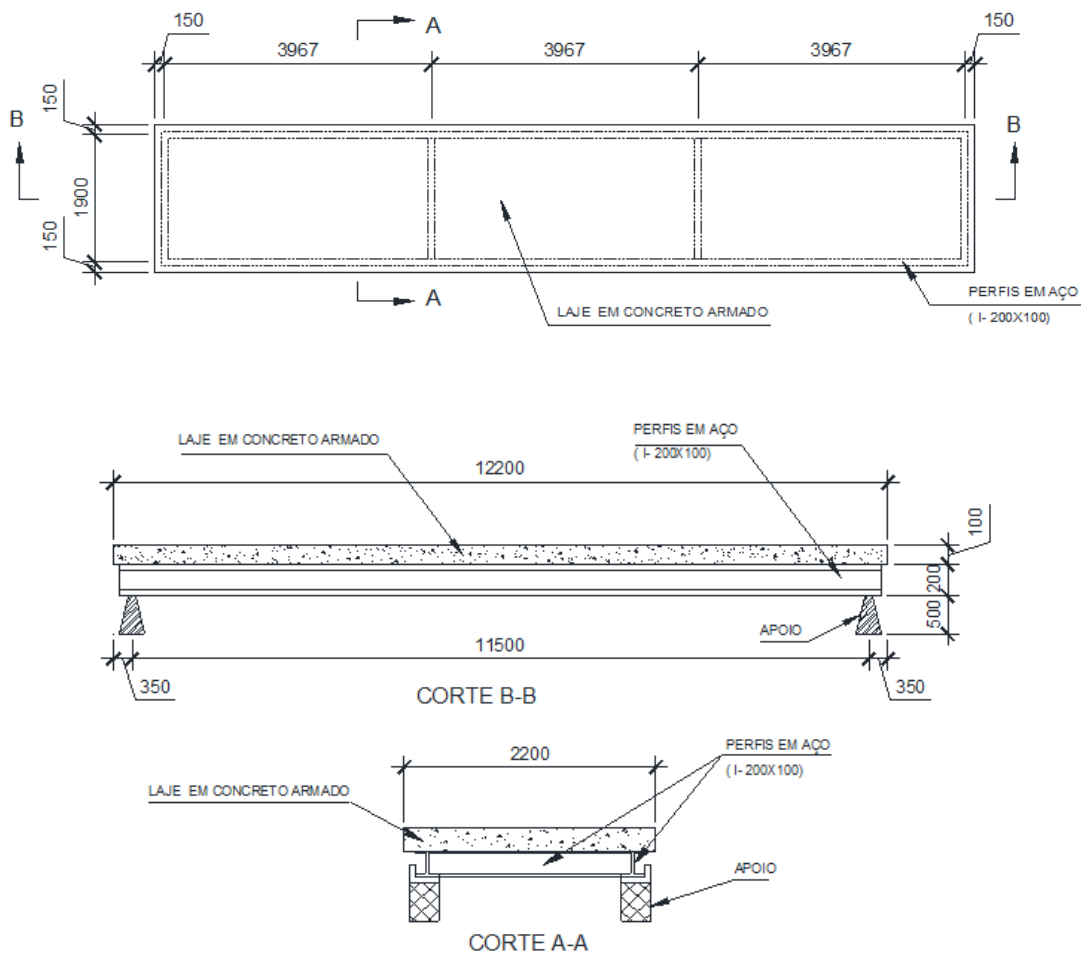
Planta baixa e cortes da estrutura (cotas em mm)
